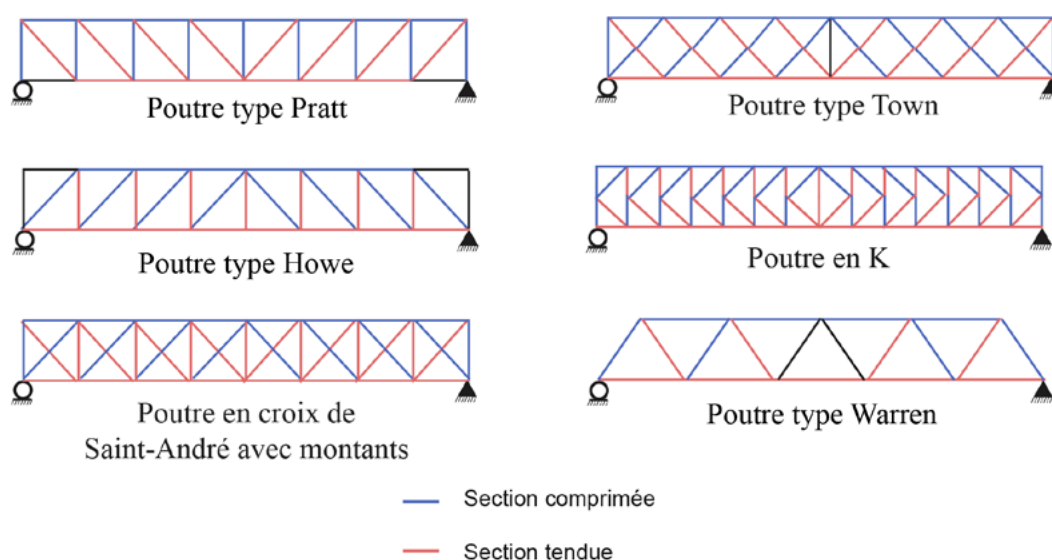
Barres comprimées ou tendues sous poids propre dans différentes poutres
